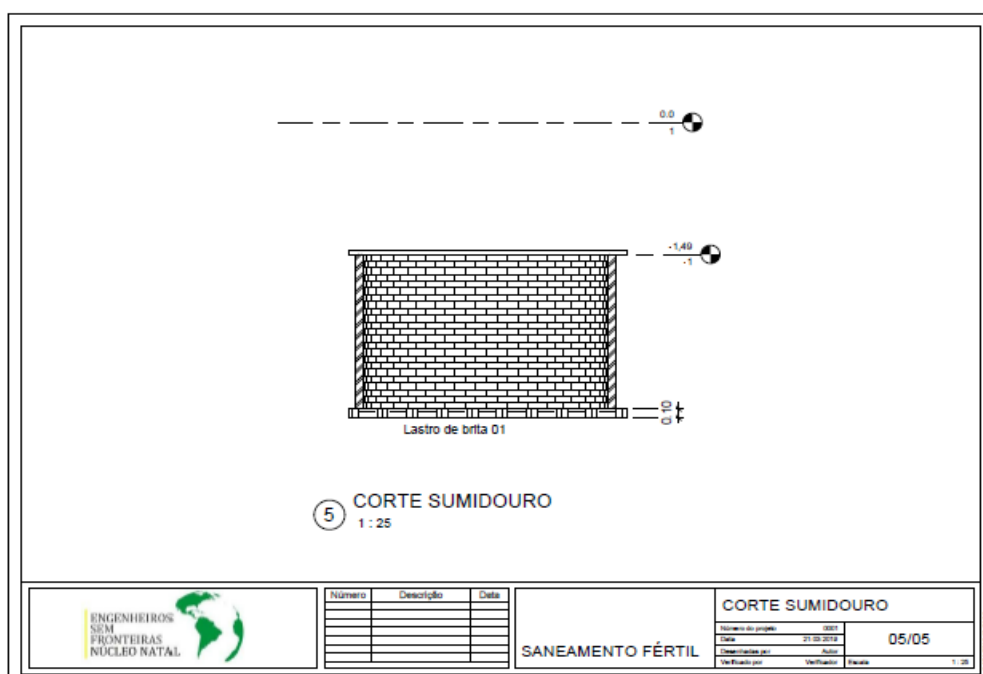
Prancha do projeto integrado do sistema de tratamento de esgoto - Corte do Sumidouro
